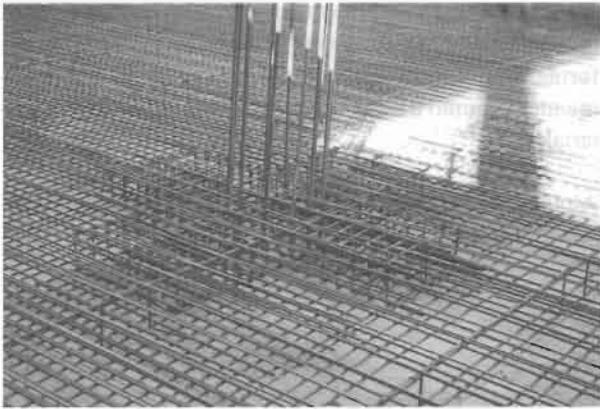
Armadura en el ábaco de una losa de hormigón armado.
